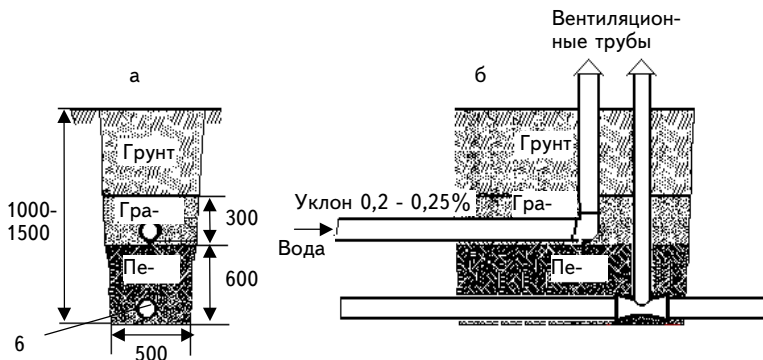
Вариант фильтрующей траншеи [18]: а) поперечный разрез; б) продольный разрез.
